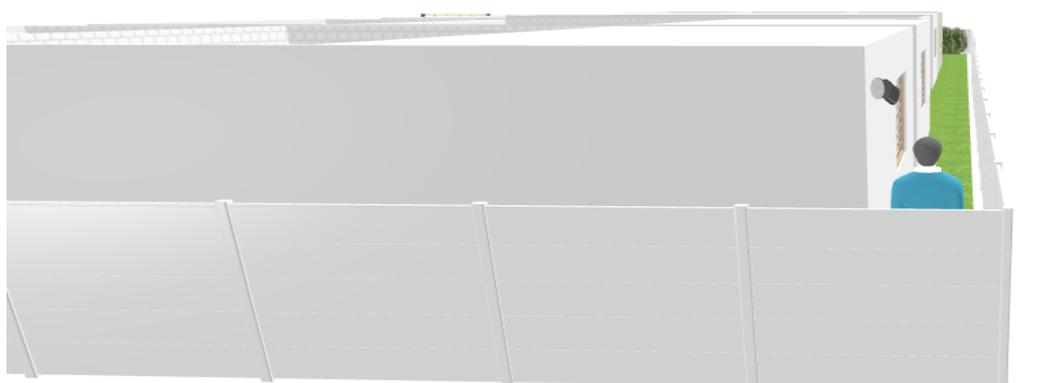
ubicación de cámara con dirección sur-suroeste.
